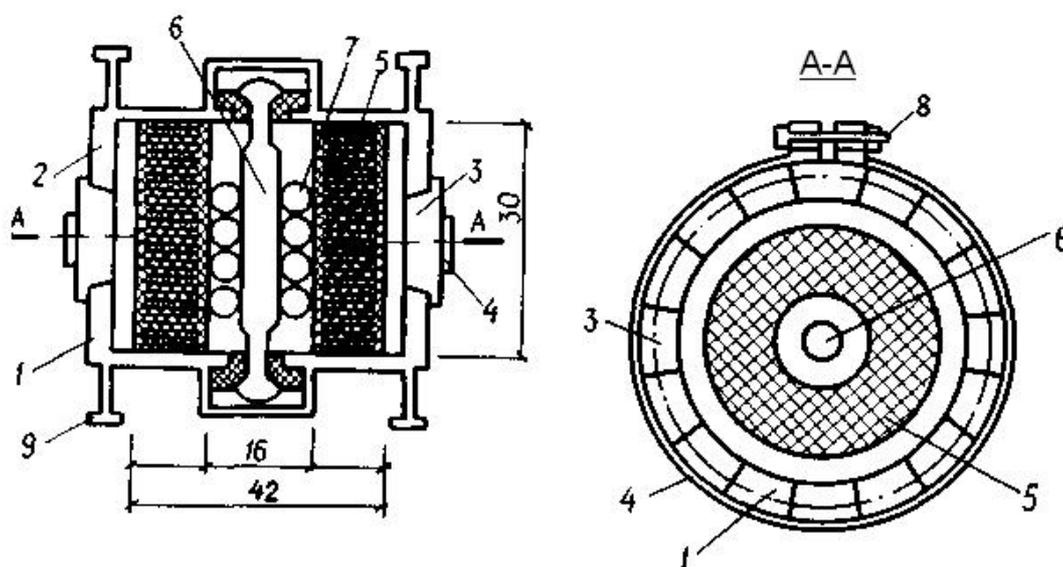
Конструктивная схема опоры с выключающимися связями жесткости (с включающимися податливыми слоистыми опорами). 1 – нижняя часть кожуха; 2 – верхняя часть кожуха; 3 – клин; 4 – запорное кольцо; 5 – резинометаллическая опора; 6 – стабилизирующий стержень; 7 – стабилизирующие кольца; 8 – болтовое соединение запорного кольца; 9 – анкер.
